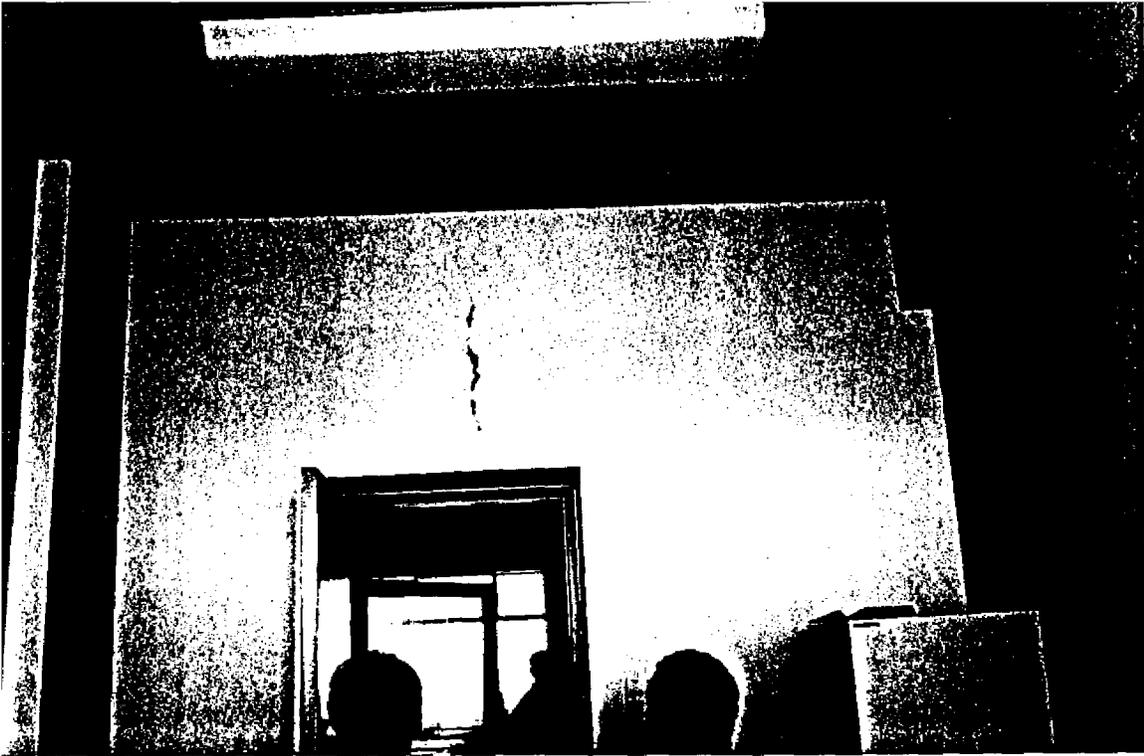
FISURA EN VIGA DINTEL DE ACOPLAMIENTO.
